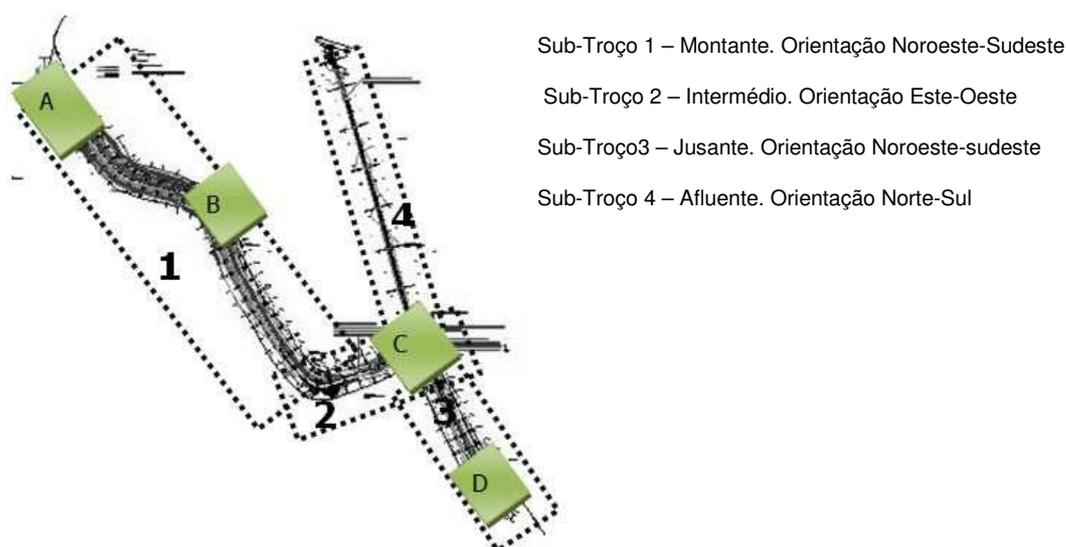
Sub-troços 1,2,3 e 4 com identificação das zonas particulares (pormenorizadas): A,B,C e D (a verde) . (S/Esc. base planta de implantação, esc. 1/200)
